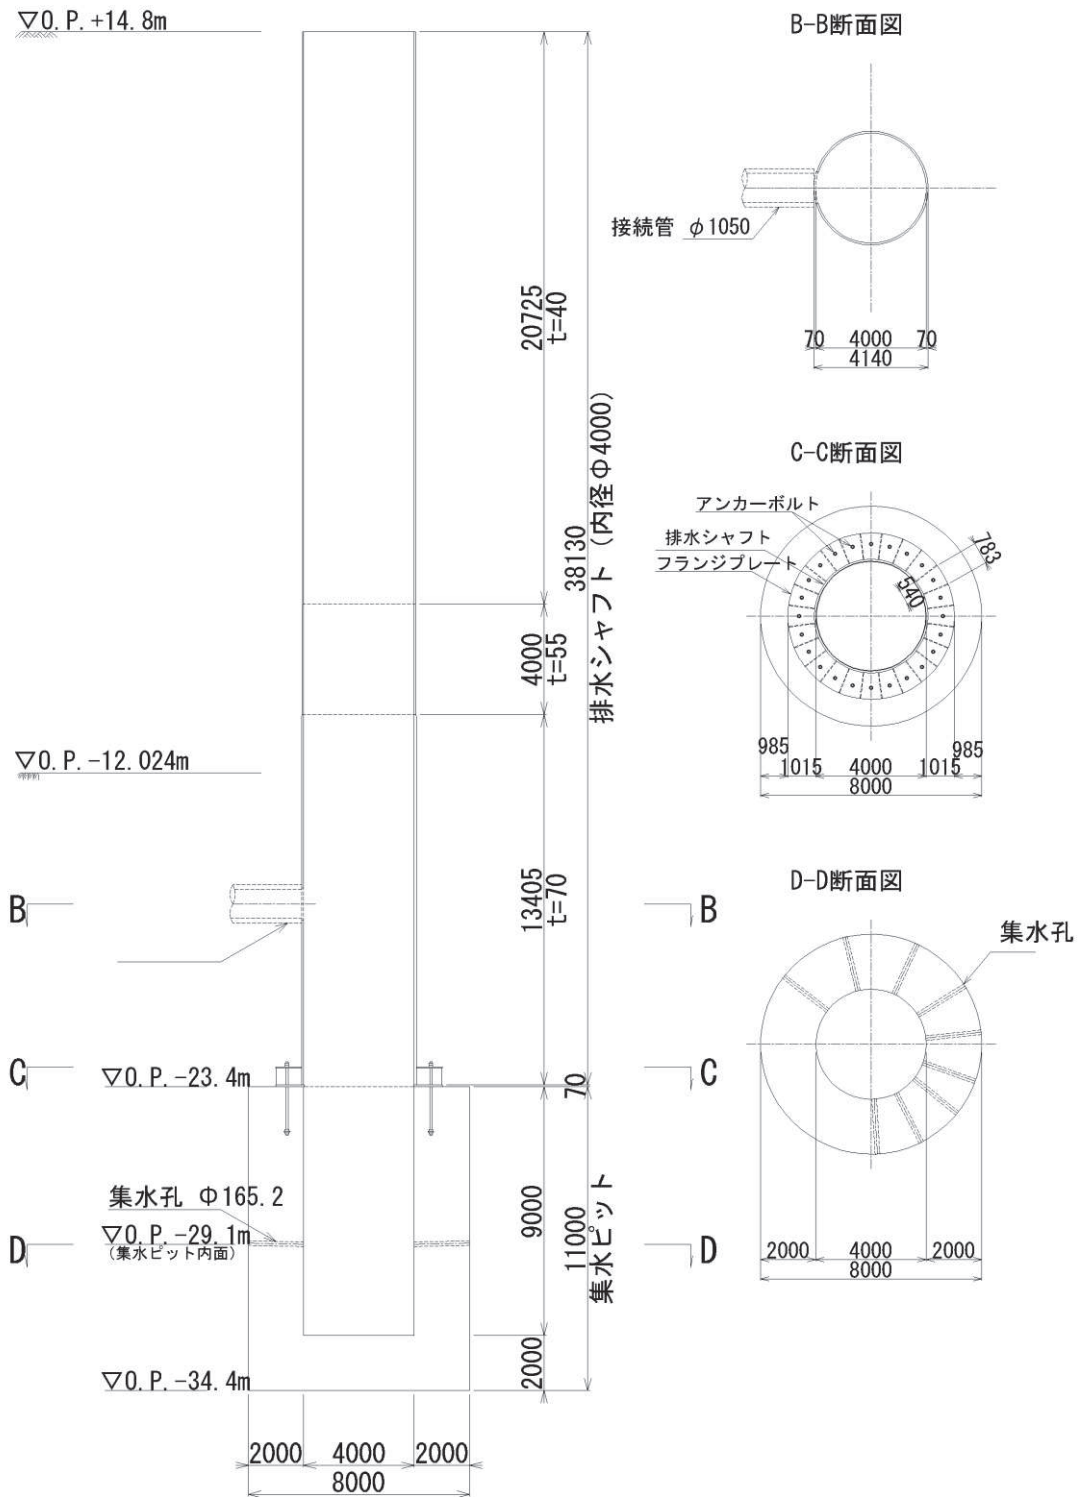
(4) No.4 揚水井戸 構造図 (単位 : mm)
